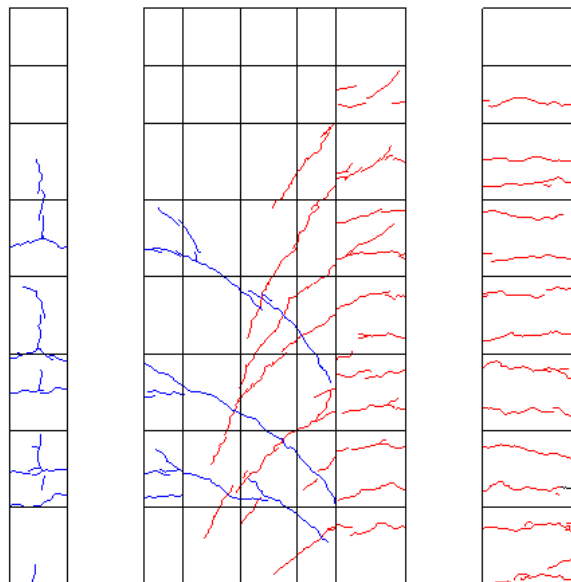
R=-1/200 ひび割れ図
